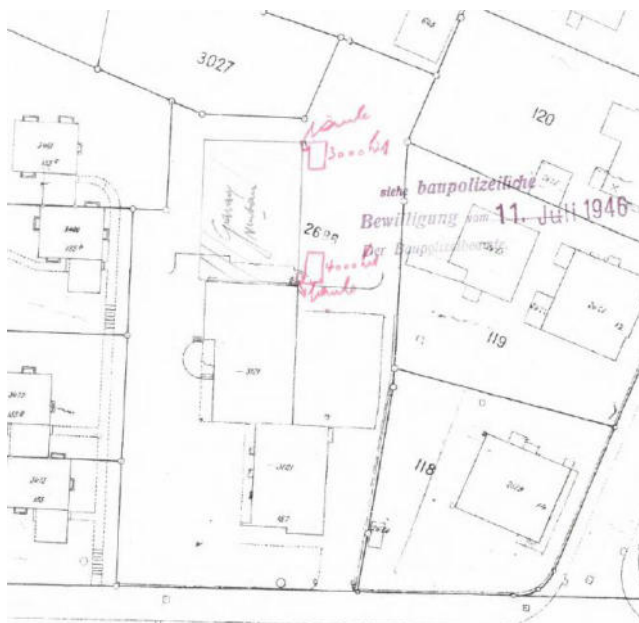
Plan 1946 mit Standorten der beiden Tanks und Säulen
